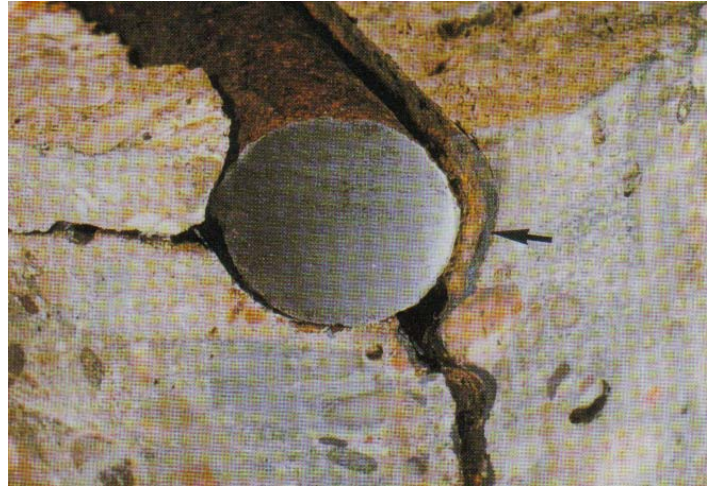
Rissbildung infolge Sprengwirkung [8]
